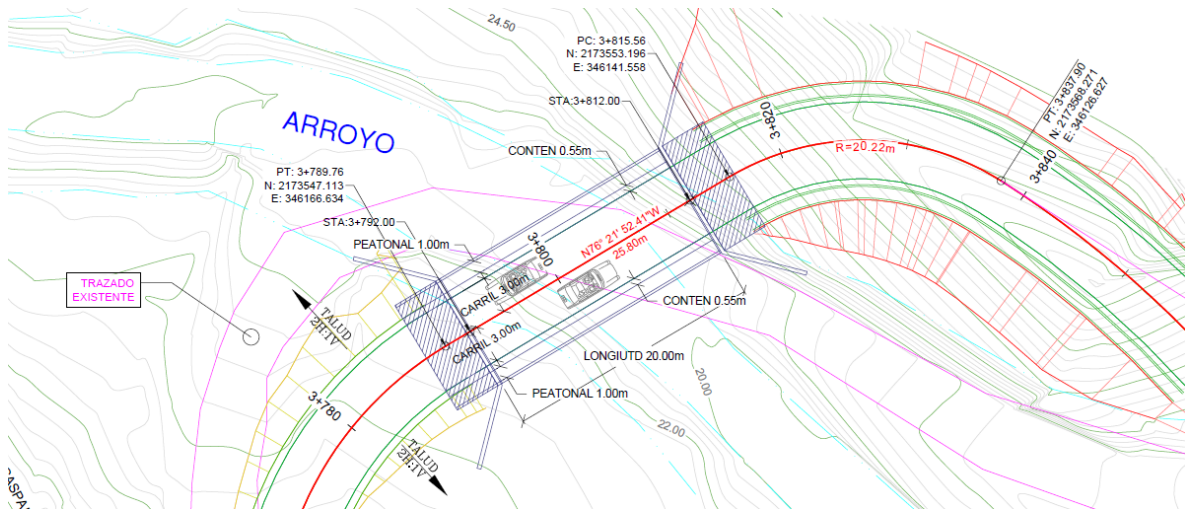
Planta dimensionada del nuevo puente sobre el Arroyo Jamao
